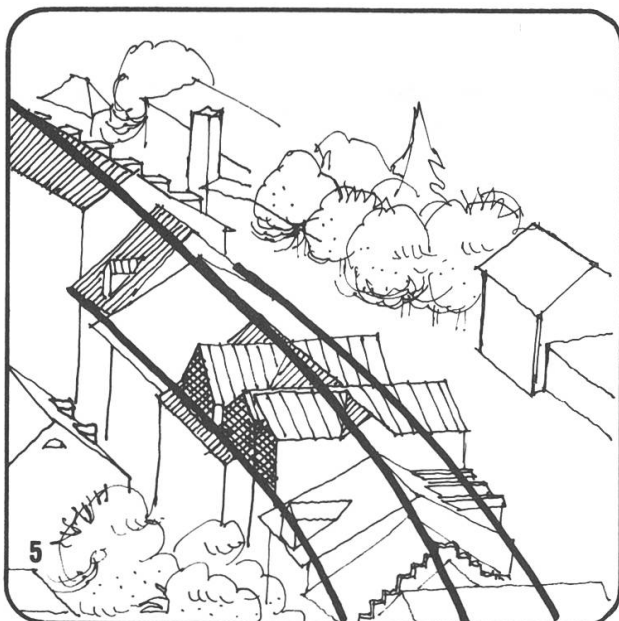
, Abrupte Firständerung (Kreuzfirst). Grossmassstäblicher Dachausbau wirkt störend auf Hufeisenform der Dachlandschaft
